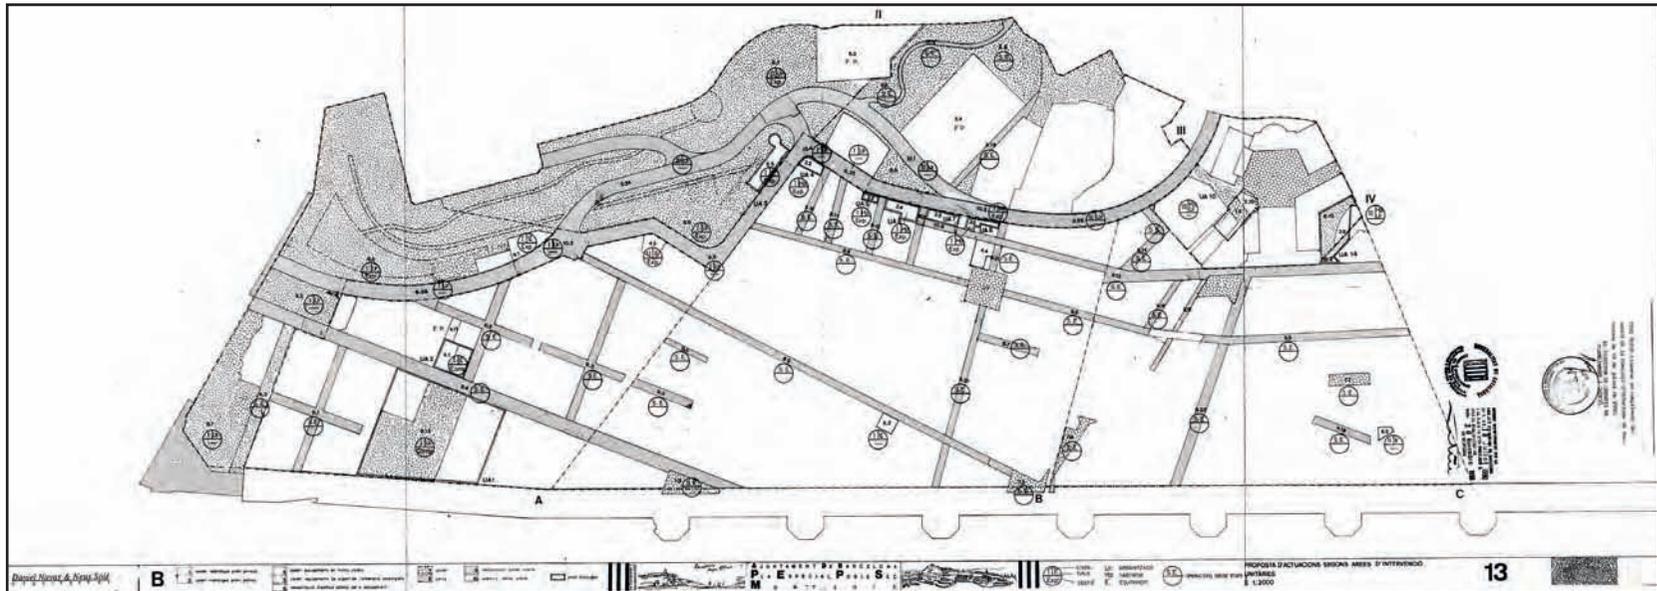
plano de propuesta de intervenciones del Plan Especial de Reforma Interior
